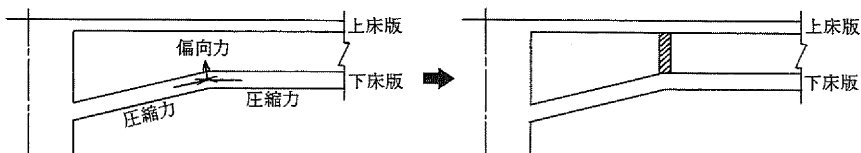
下フランジの圧縮力による偏向力と横断の配置
